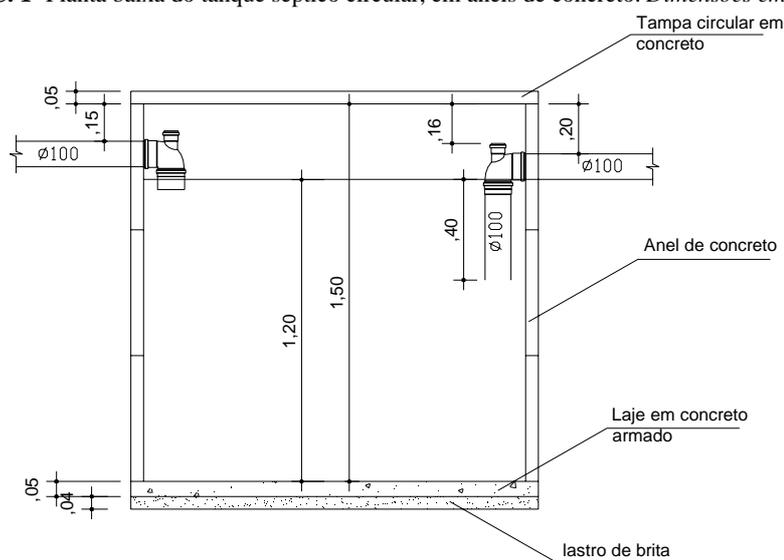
Perfil do tanque séptico circular, em anéis de concreto. *Dimensões em metros (m).
